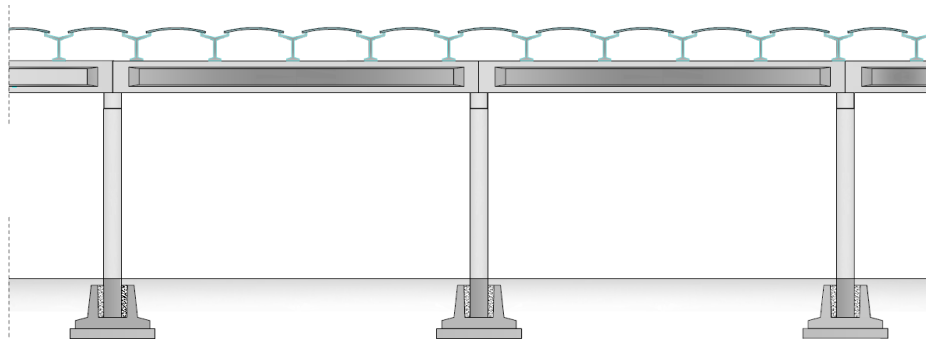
Exemplo de cobertura com vigas em Y apoiadas em vigas I [12]
